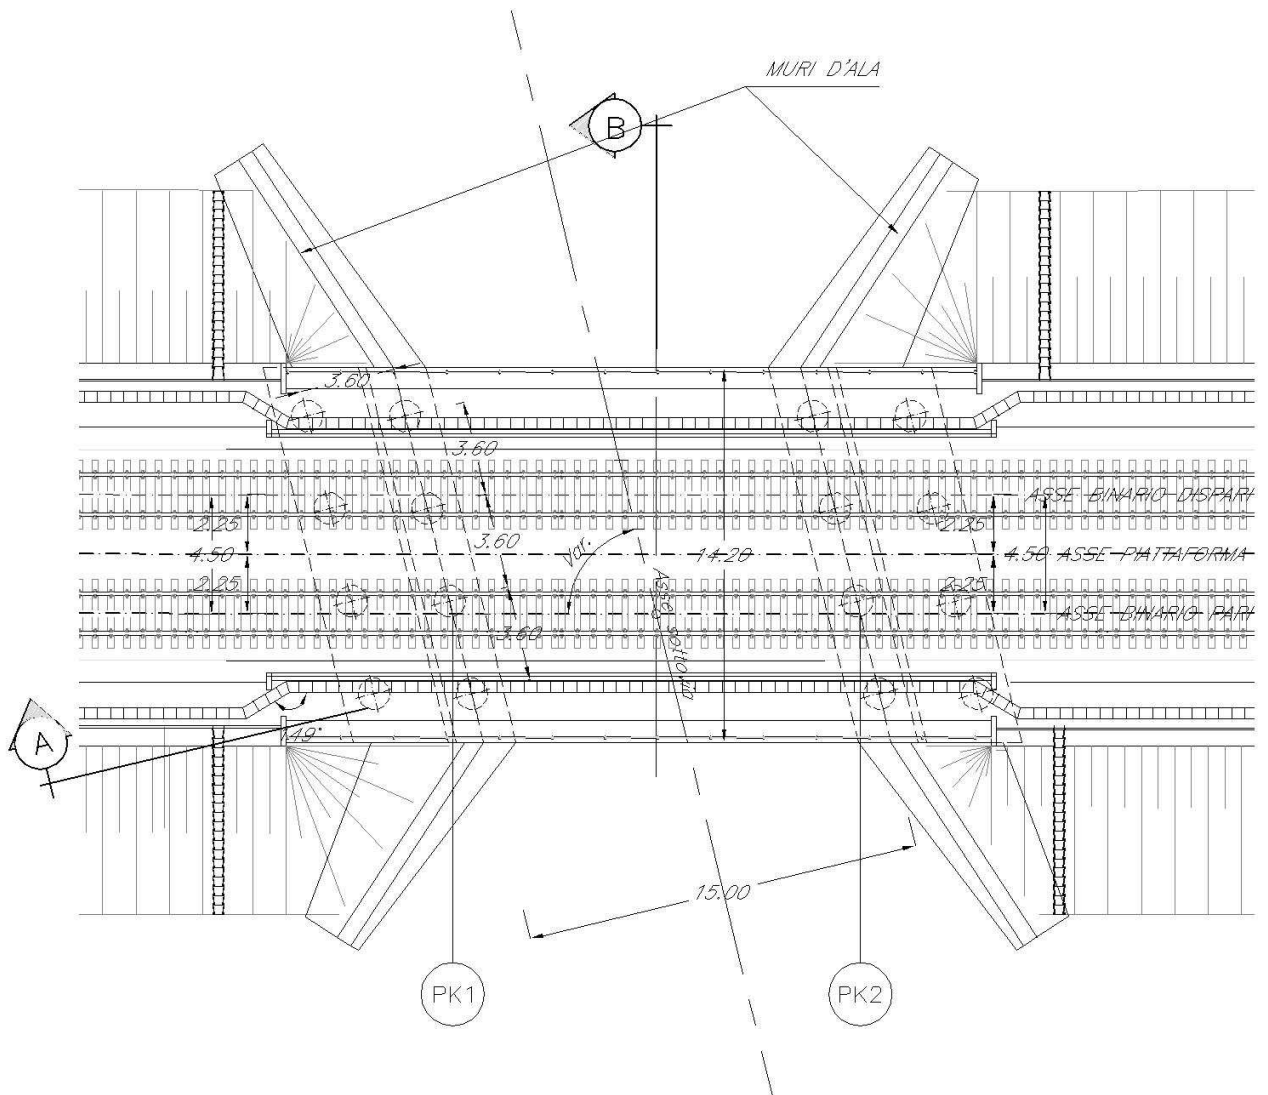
Prospetto in corrispondenza di attraversamento idraulico.
